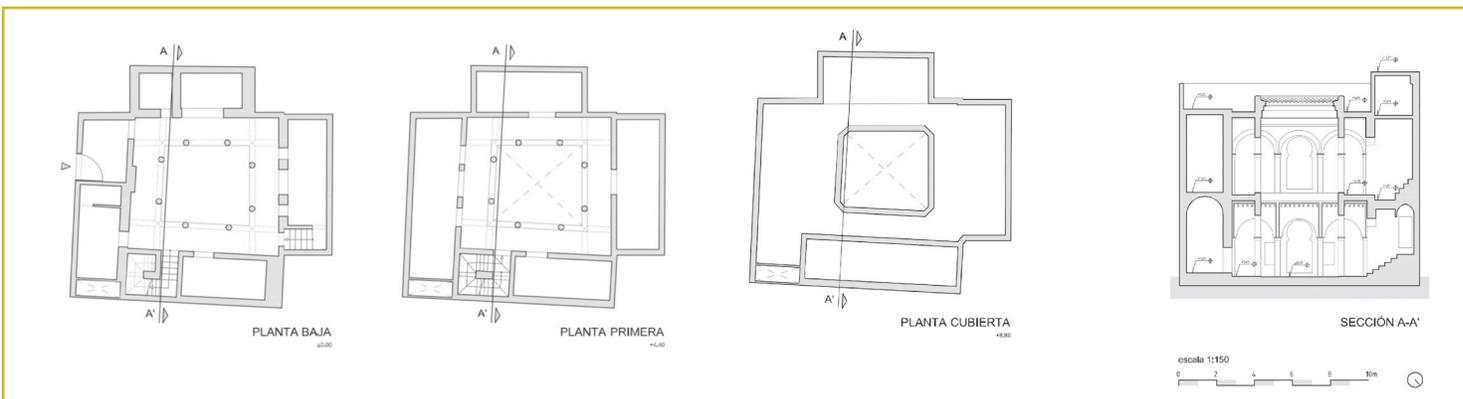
Plantas y corte de la casa dar Ben Abdeluahab (fuente: Los autores).
